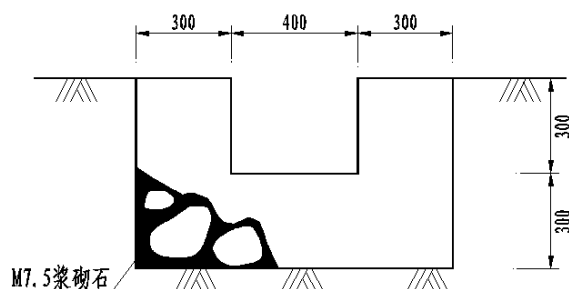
排水沟典型设计断面示意图 (单位:cm)
